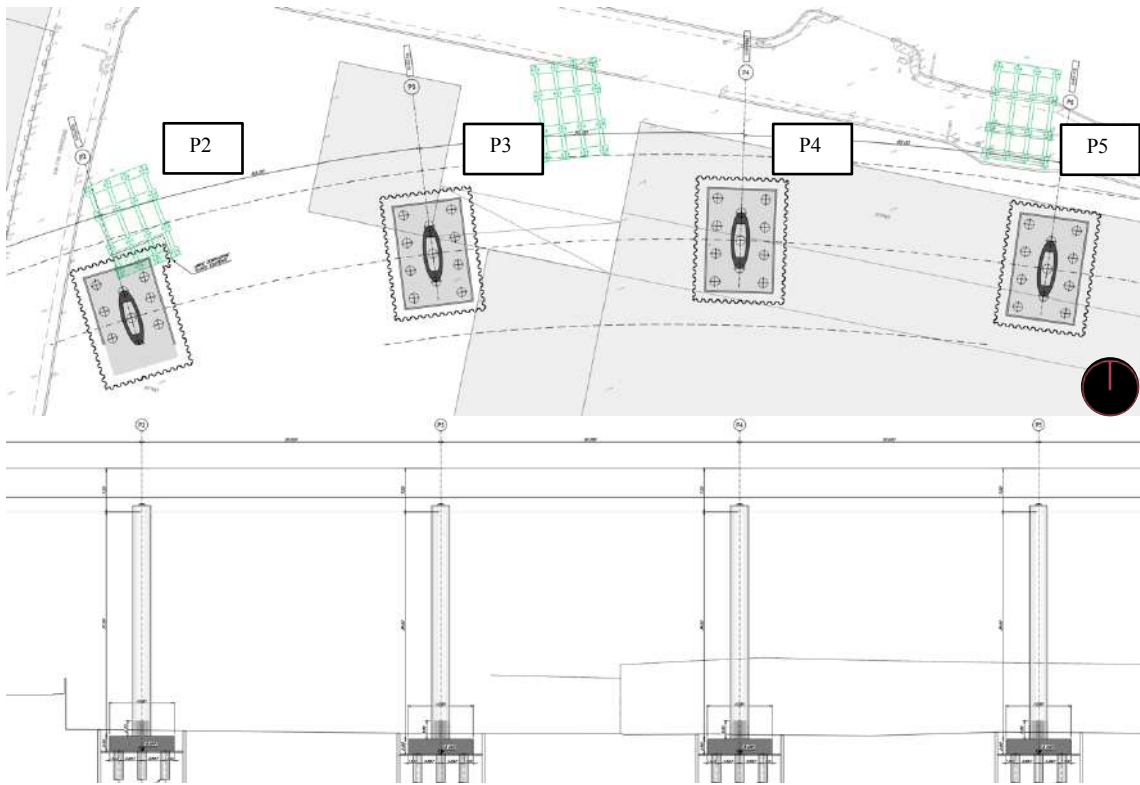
Planta e elevação lateral dos pilares elípticos P2, P3, P4, P5 e respectivas fundações. Fonte: Adaptada de ITALFERR
